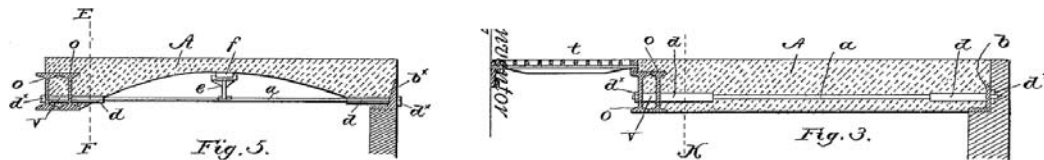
Vorgespannte Betonfertigteilelemente nach Jacksons Patent, Längs- und Querschnitt
